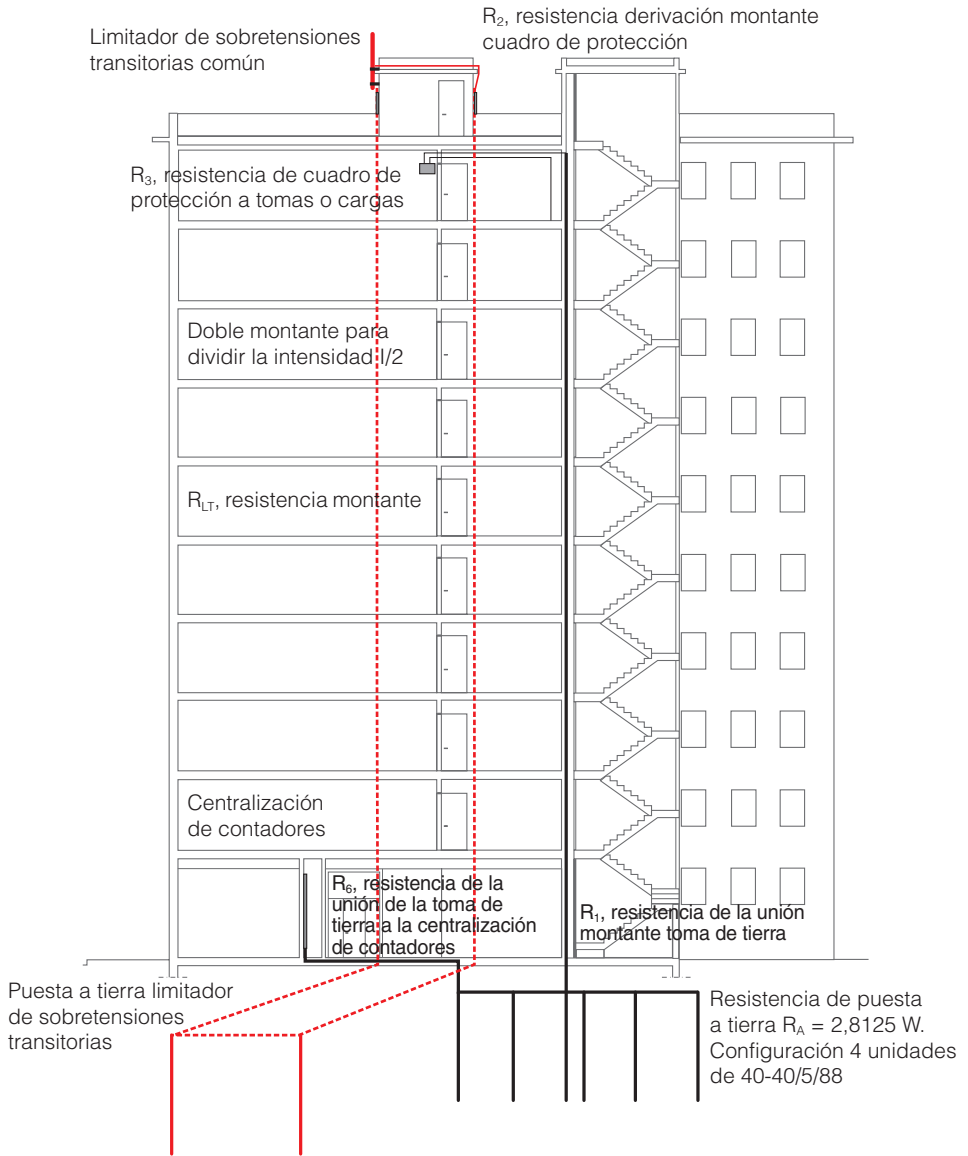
situación en alzado de las puestas a tierra.
